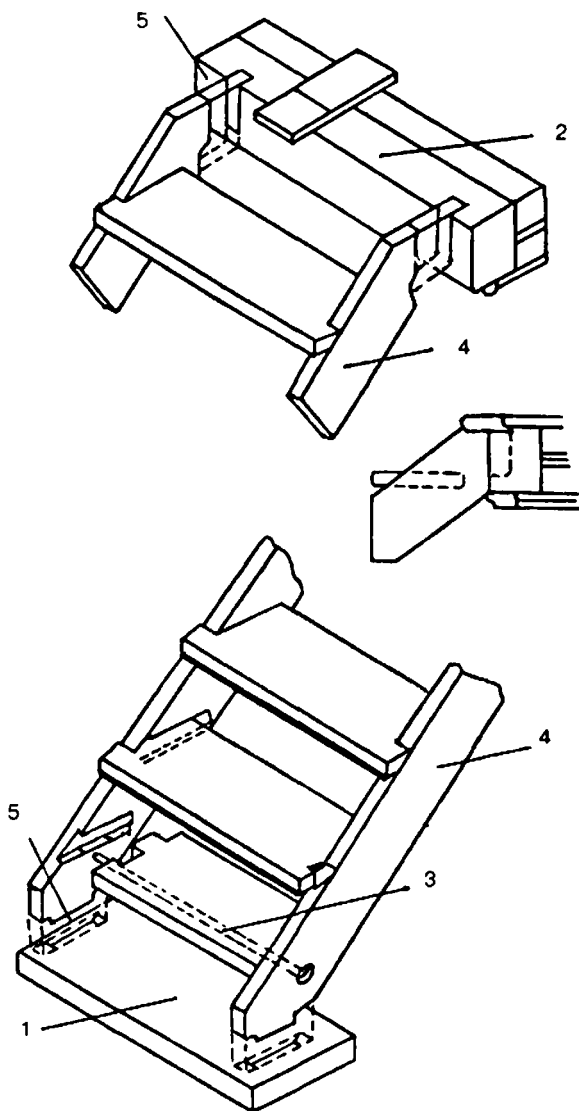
Вариант крепления одномаршевой лестницы к поперечным опорным балкам:
